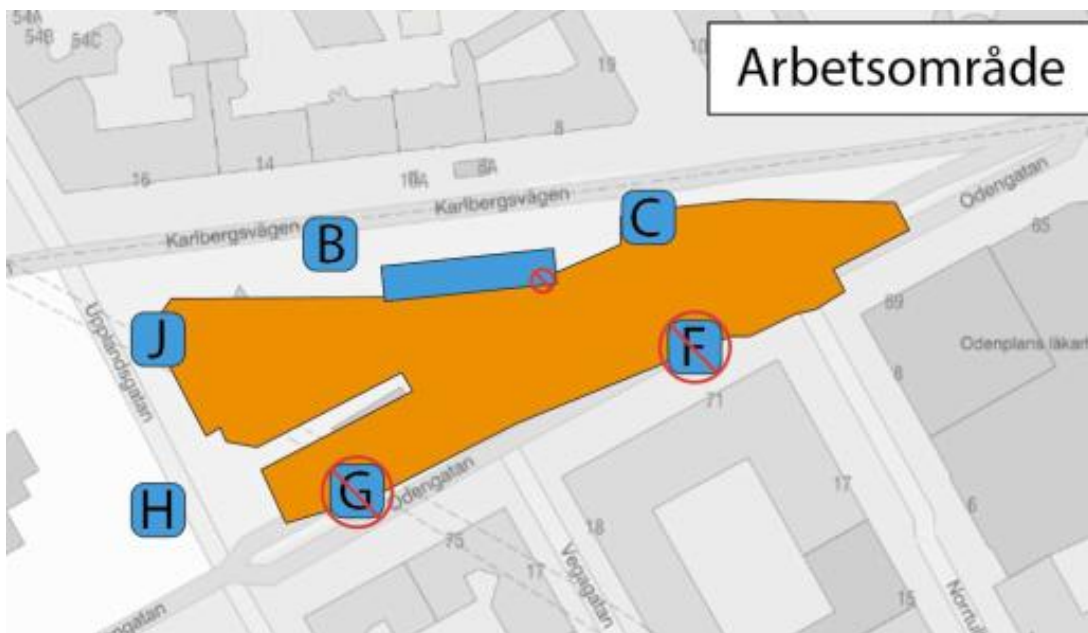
Planerat markanspråk ovan jord vid Odenplan.
